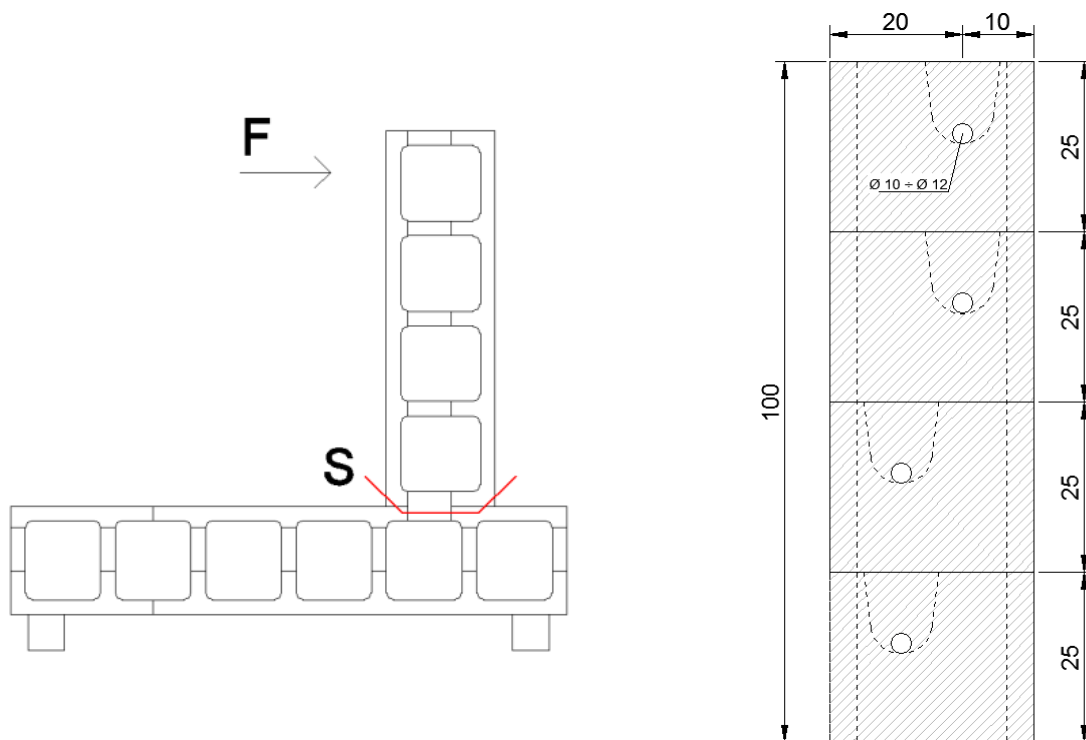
Sezione debole nei muri a L e vista della sezione resistente adottata
